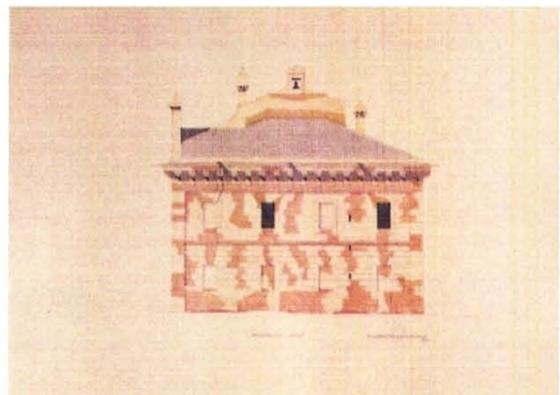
prospetto ad ovest. Quadro fessurativo e stato di degrado della muratura
